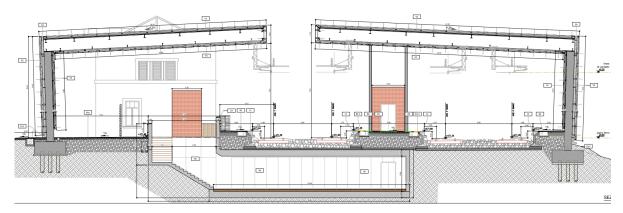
Sezione trasversale dell'ingresso in stazione e sottopasso esistente.
